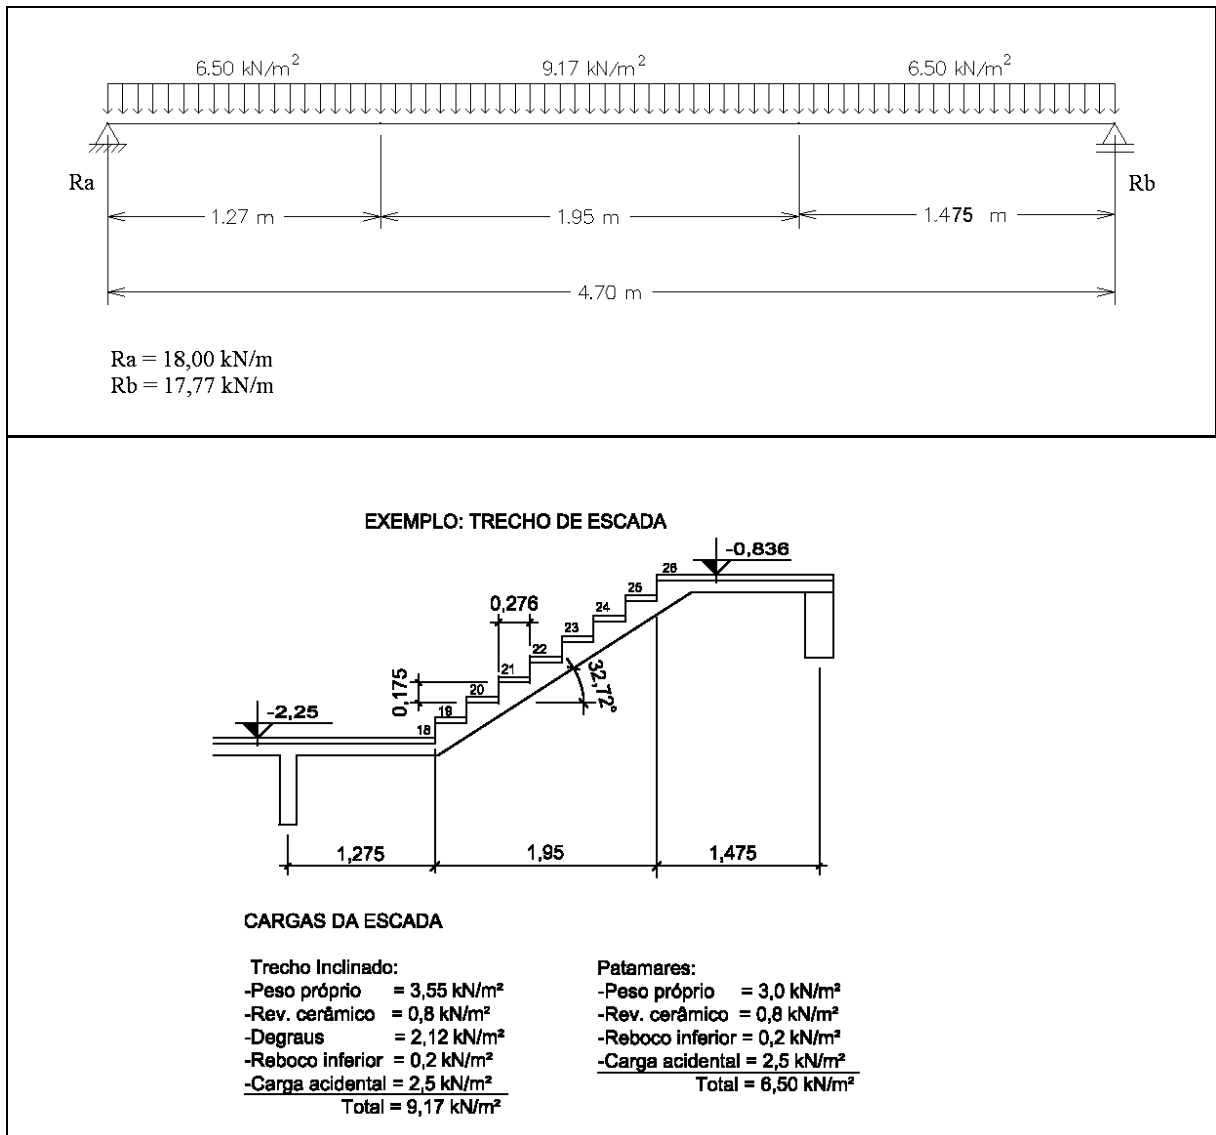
cargas distribuídas sobre as vigas devido às lajes do patamar da escada
